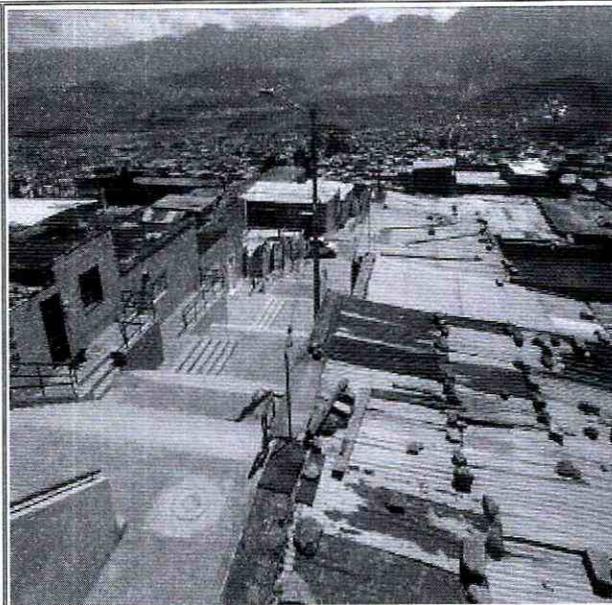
Acceso peatonal costado norte (Calle 78 Sur) manzana 56 Barrio Naciones Unidas Santa Rosa
